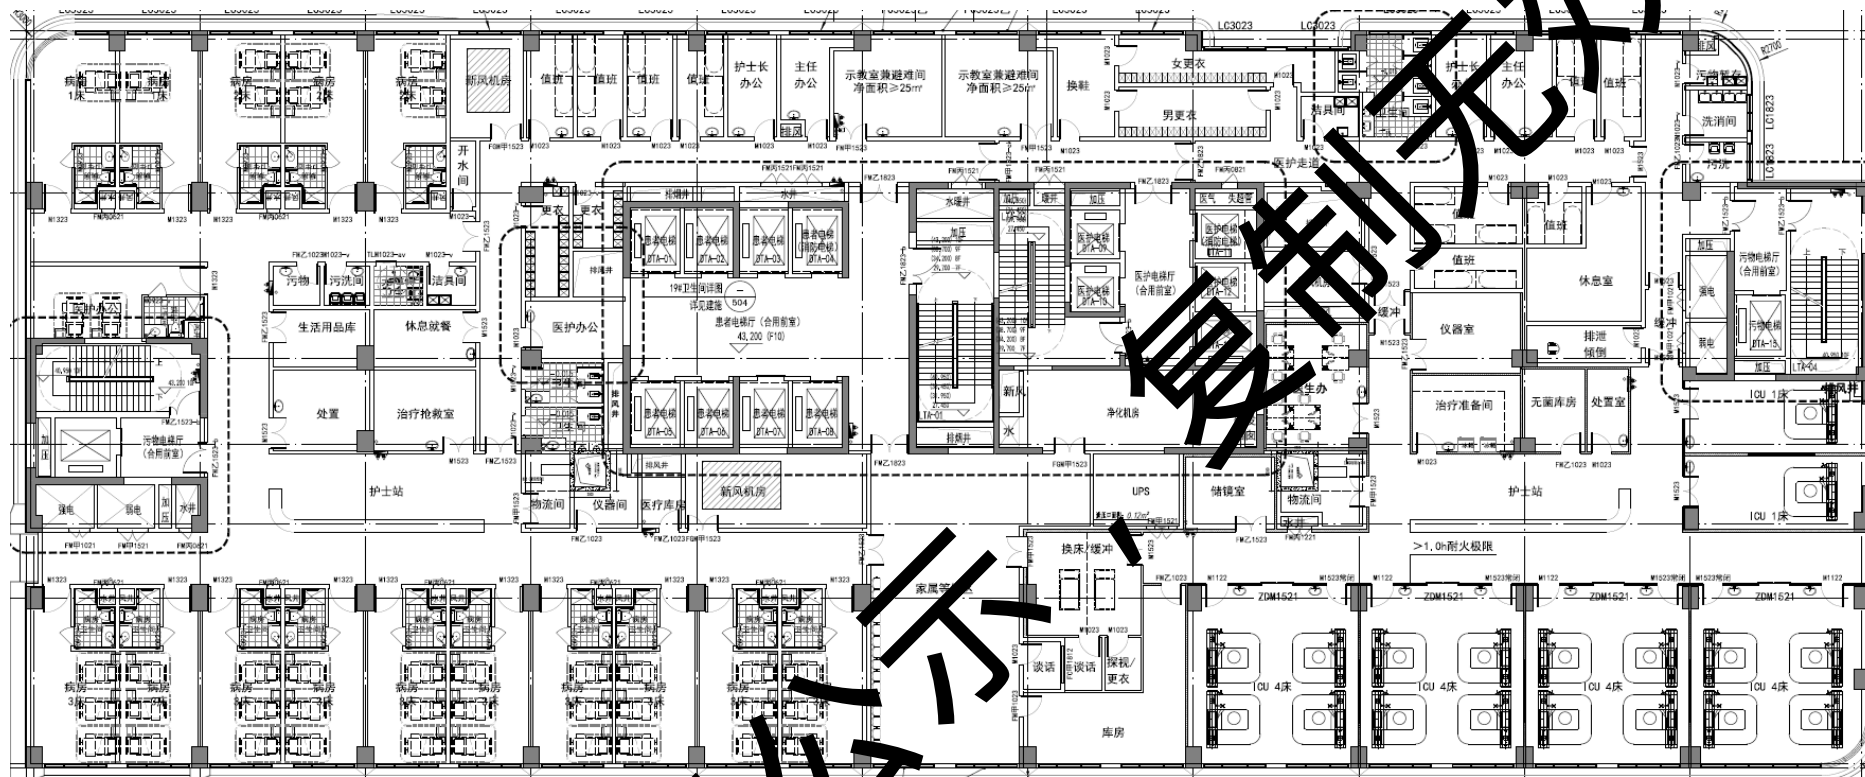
本项目新建住院综合楼 10F 平面布置图
